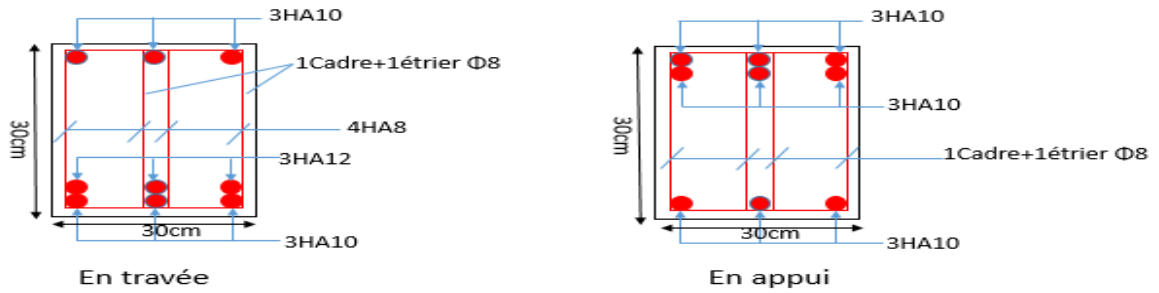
Schéma ferrailage de la poutre de chaînage.
